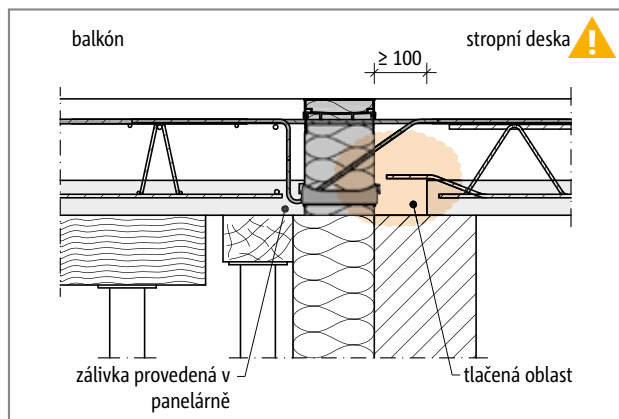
Schöck Isokorb® typ KXT: Prefabrikovaný balkón, jehož spodní hrana je snižena vůči stropní desce uložené na předem vybetonované železobetonové stěně
